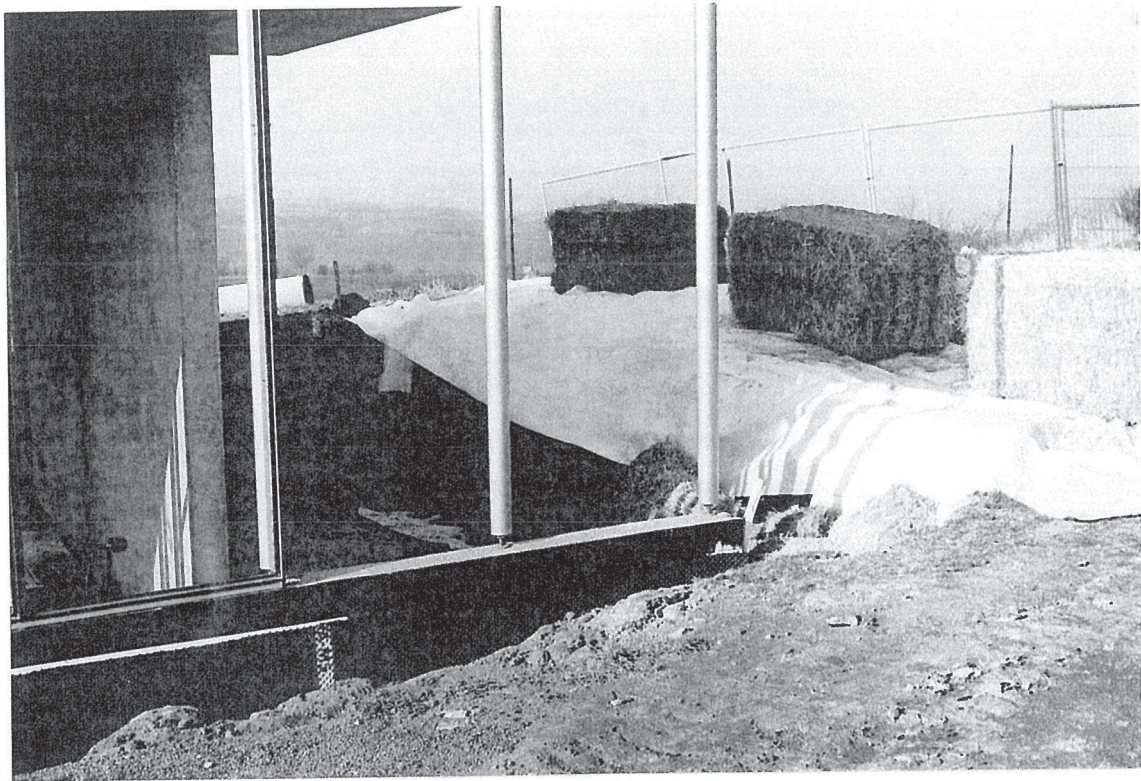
Montpeyroux (63) – dispositif de protection contre les surpressions et les projections sur un tir à faible distance d'un bâtiment.
